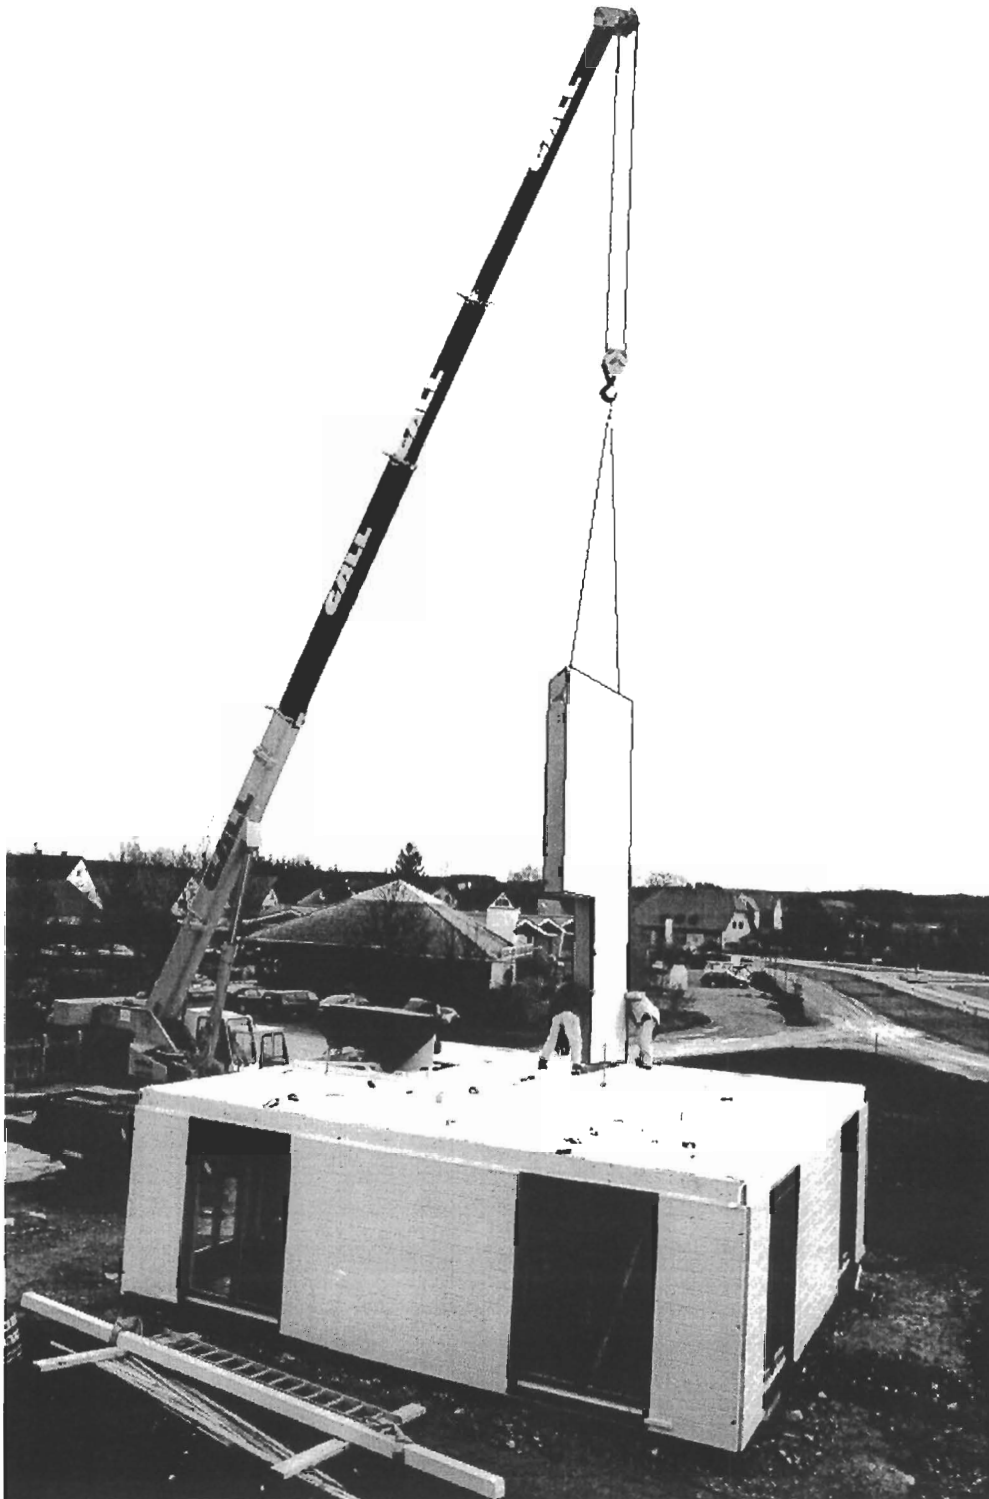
Einbau eines vorgefertigten Installationskernes in ein Fertighaus. Bereits bei Anlieferung auf der Baustelle enthält der Installationskern alle Leitungen, Rohre, Montageelemente und Haltevorrichtungen für die Haustechnik.
